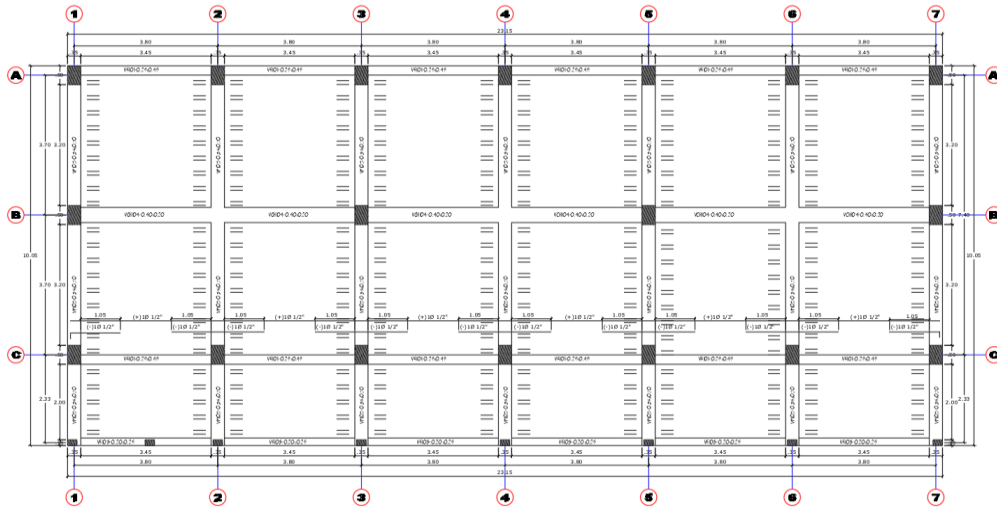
Encofrado de losa aligerada típico del primer y segundo piso.
